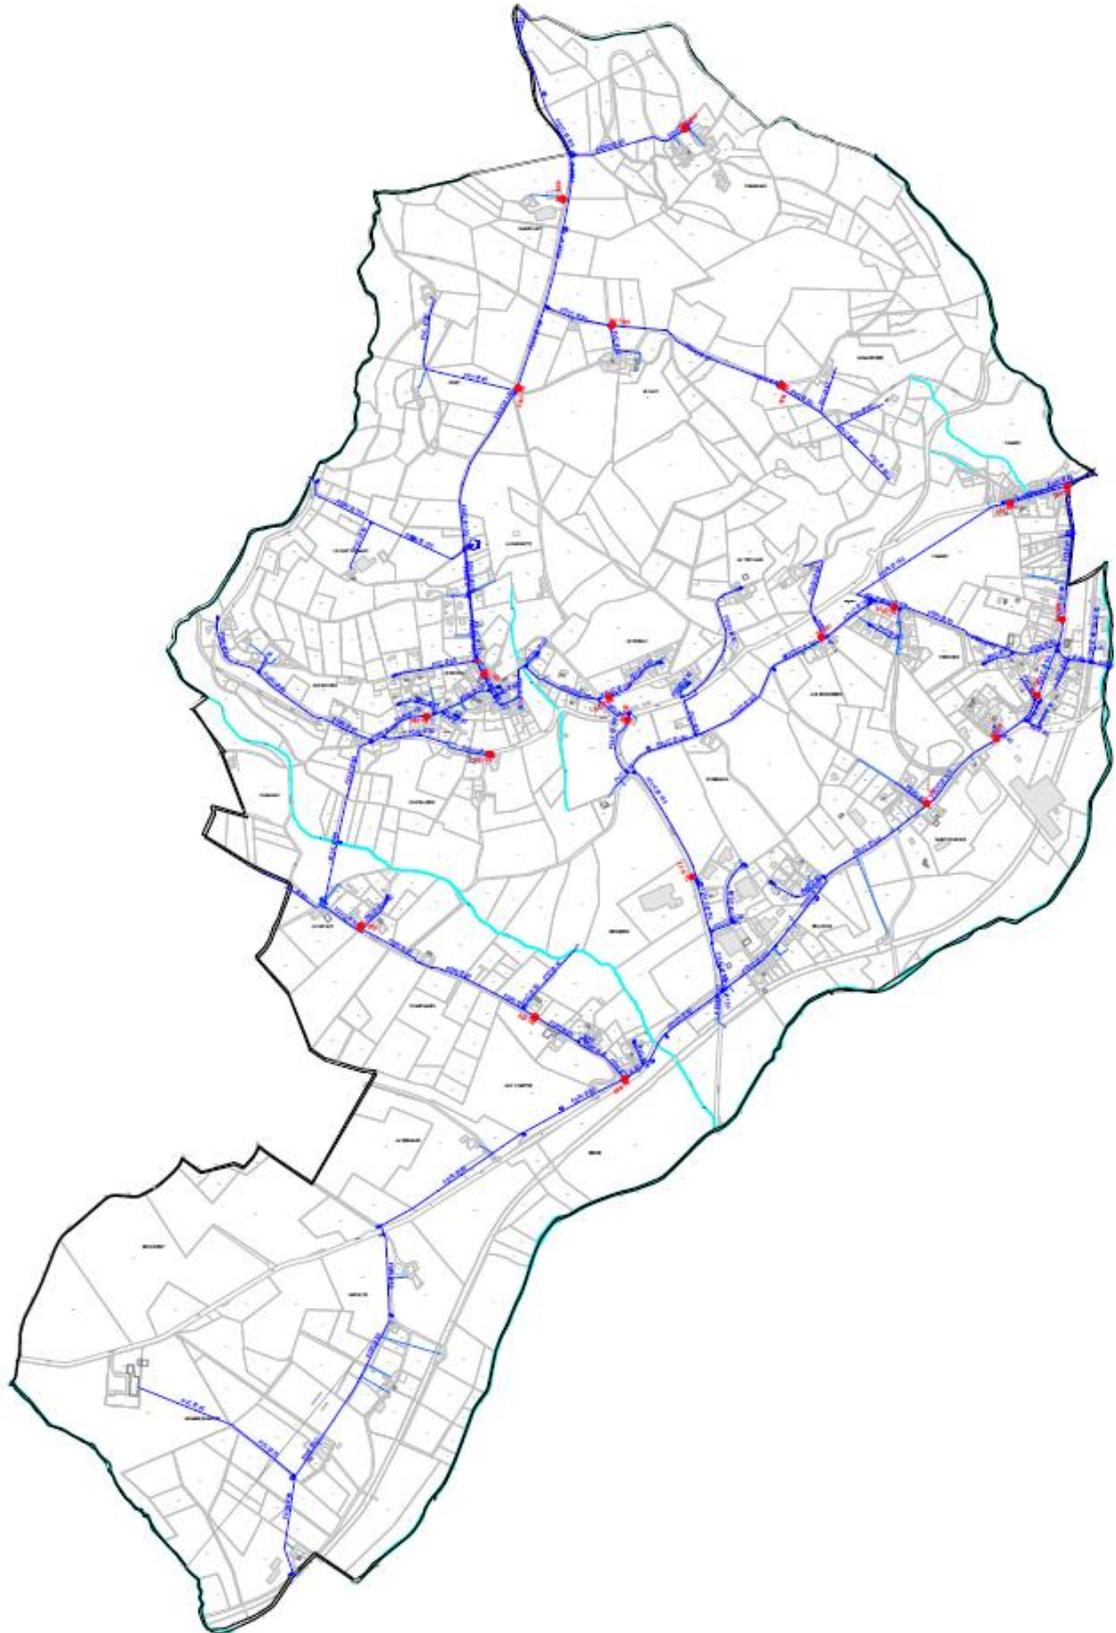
Plan du réseau d'eau potable sur la commune de Souzy. Source : Lyonnaise des Eaux, 2015.
